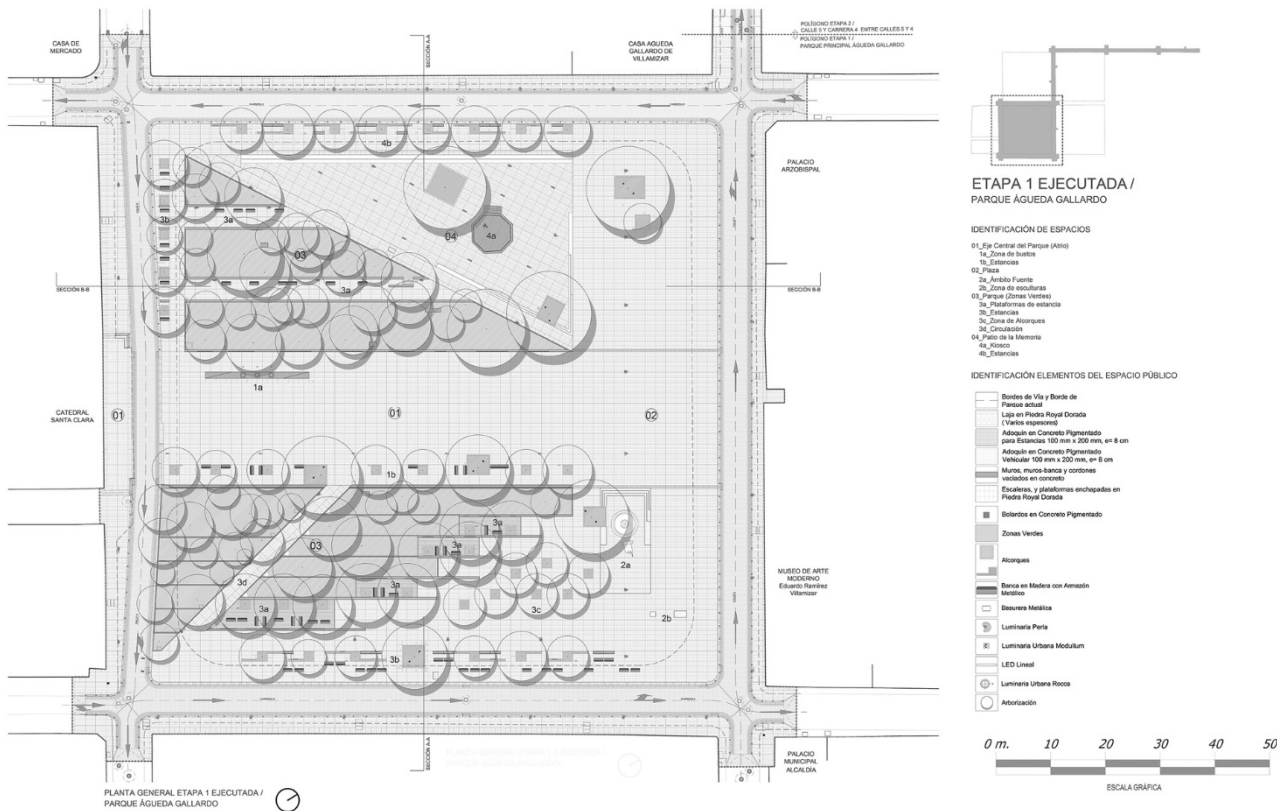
Planta arquitectónica - Parque Águeda Gallardo
